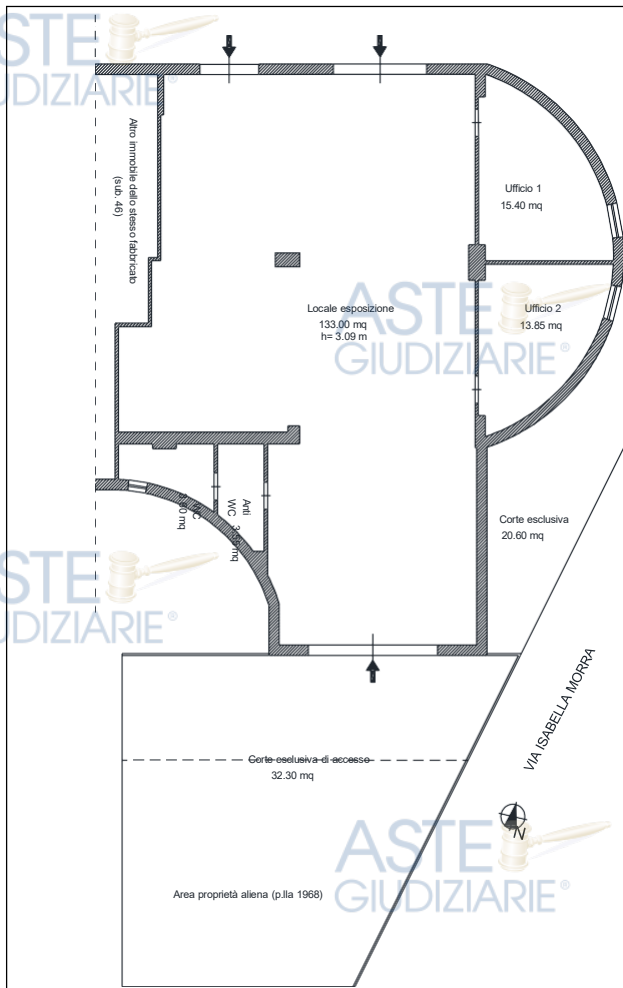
Pianta di rilievo del locale terraneo di cui al Lotto 1
